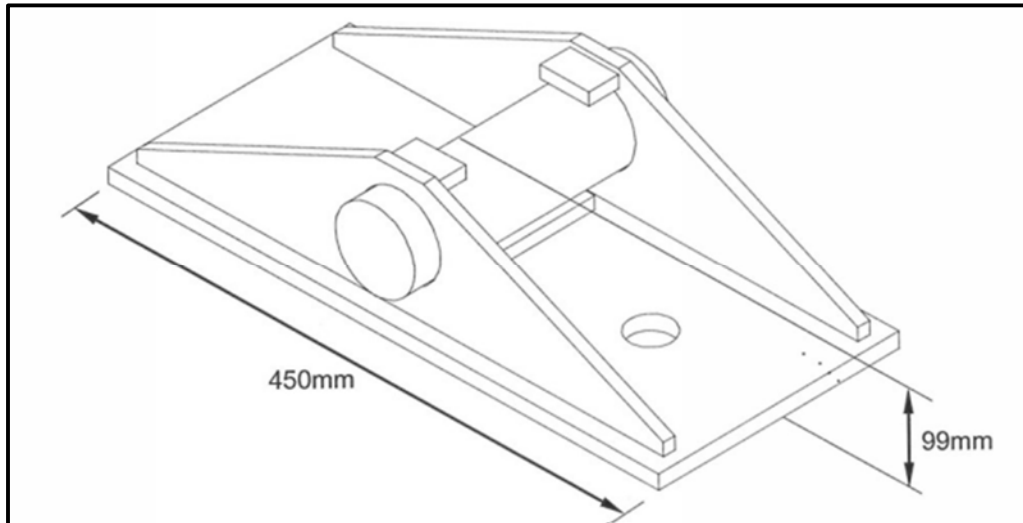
Condición de apoyo: Puente Bailey tipo Mabey
